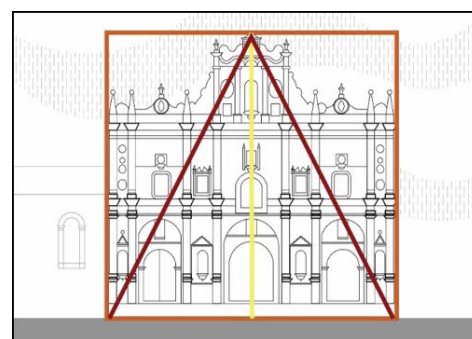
Cuadrado base en la fachada. Fuente: Realizado por el autor.
